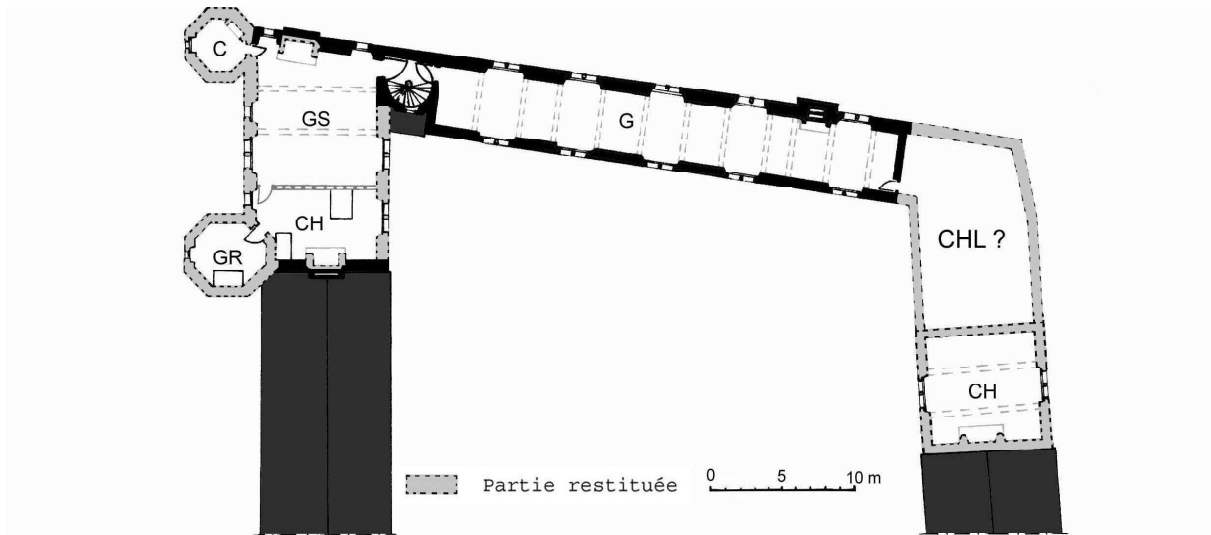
Les Maillets. Plan restitué du premier étage entre 1535 et 1545.
